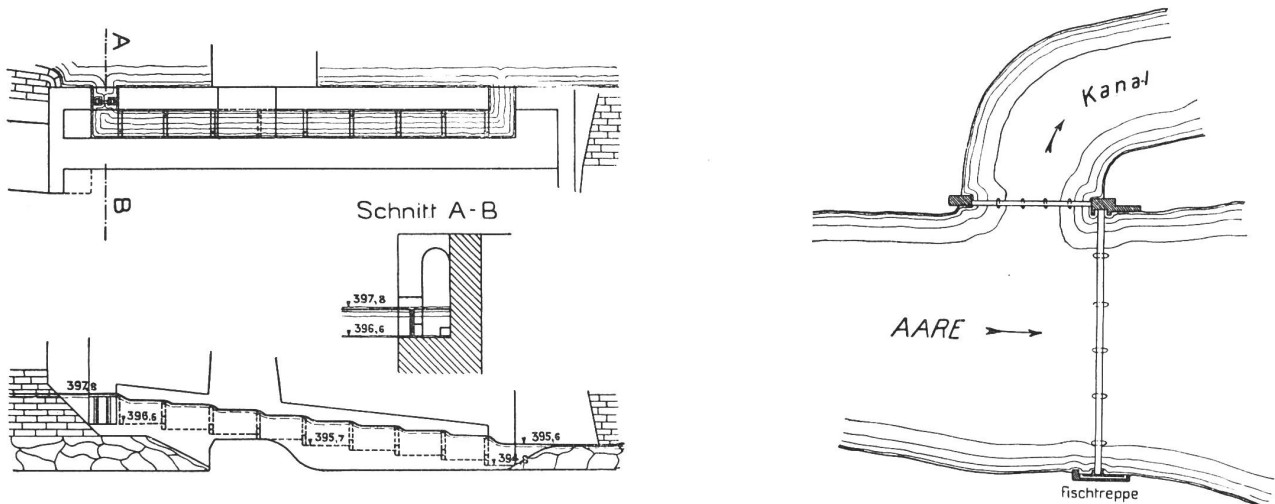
Elektrizitätswerk Ruppoldingen. Situation der Wehranlage und Grundriss sowie Schnitte durch die Fischtreppe. Maßstab 1 : 300 und 1 : 2000.
